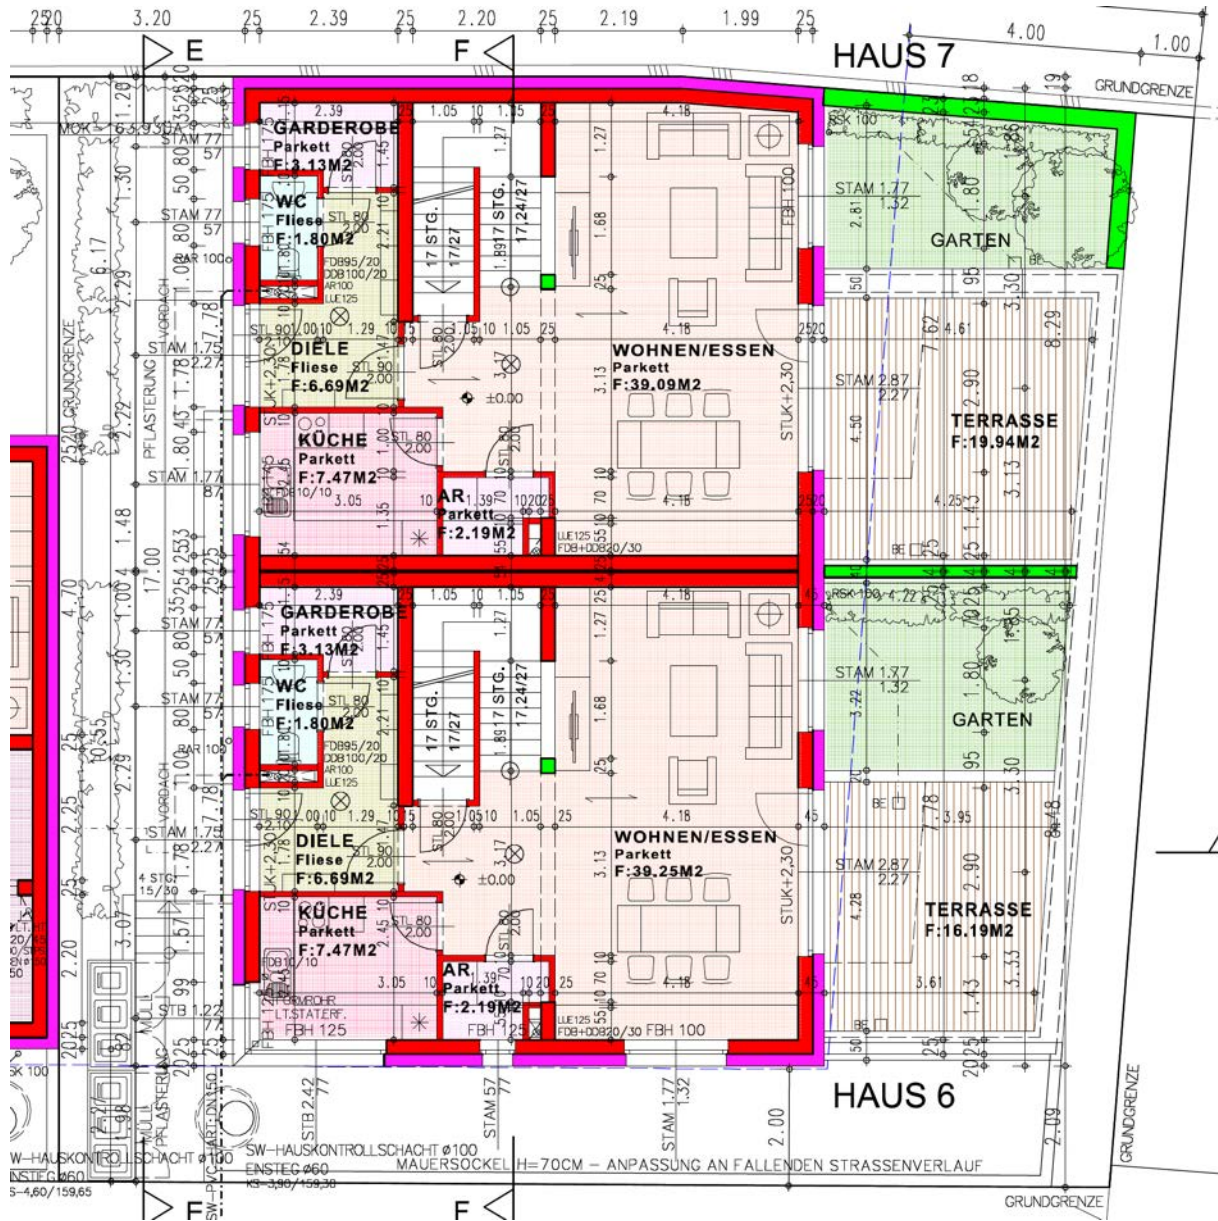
Einreichplan – Erdgeschoss Haus 6+7 / Quelle: auftraggebende Partei
